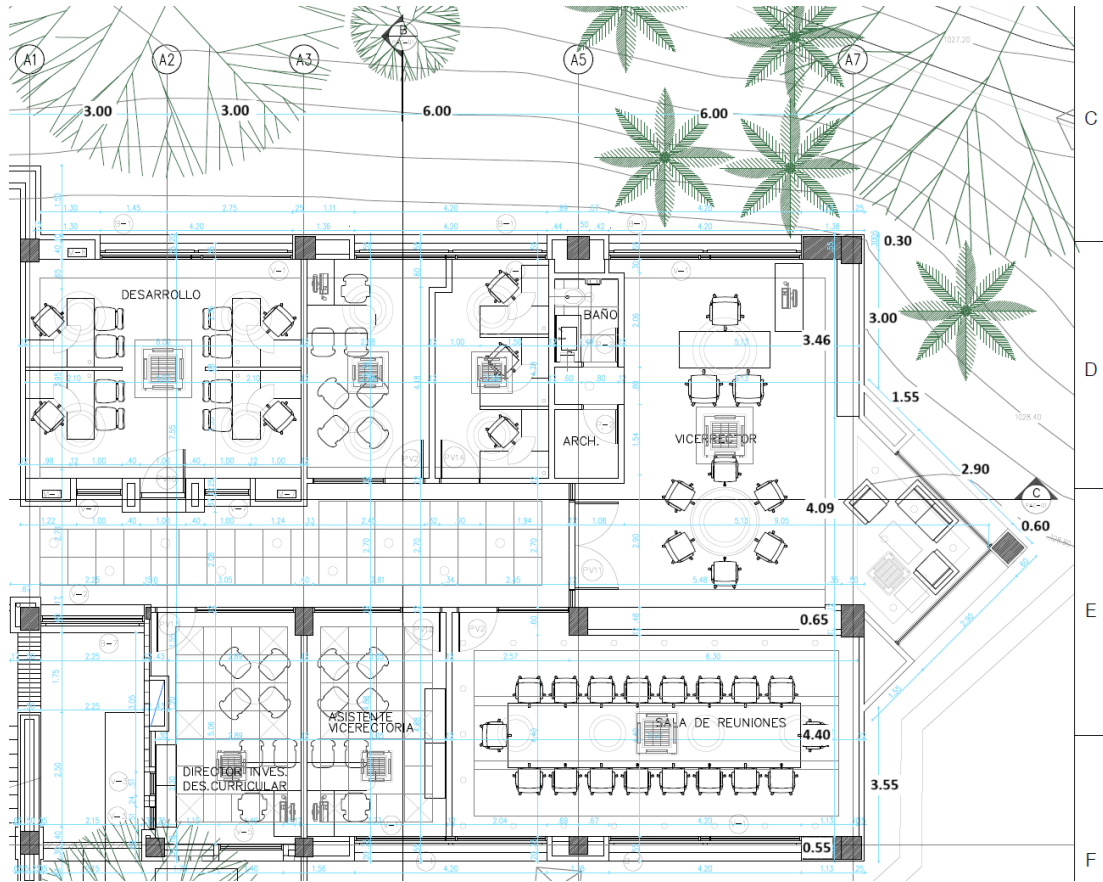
Planta primer piso del edificio administrativo ala este (Ortizcampo, 2022).
